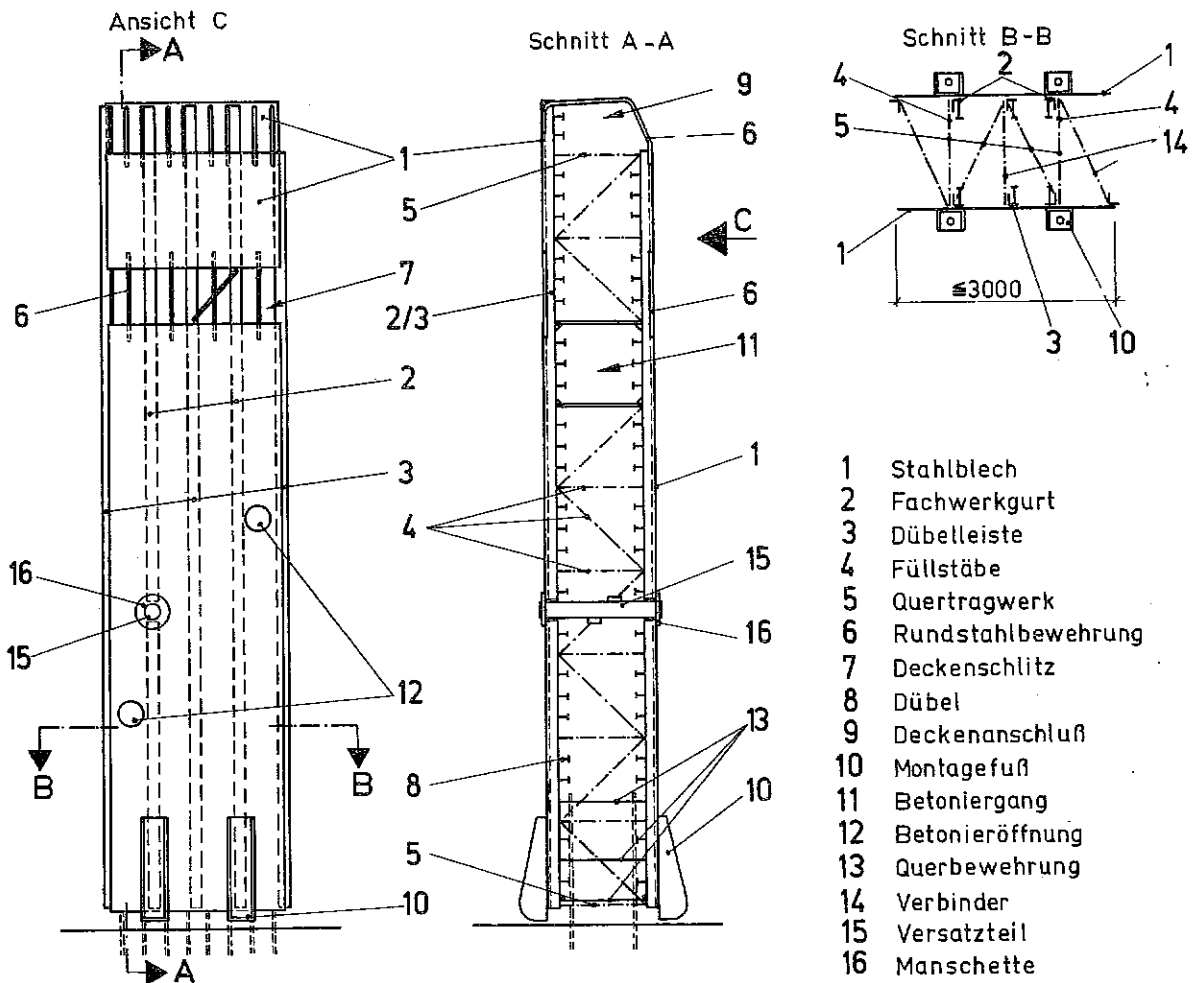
Konstruktionsprinzip der Wandzellen mit zweiseitiger Blechbewehrung
